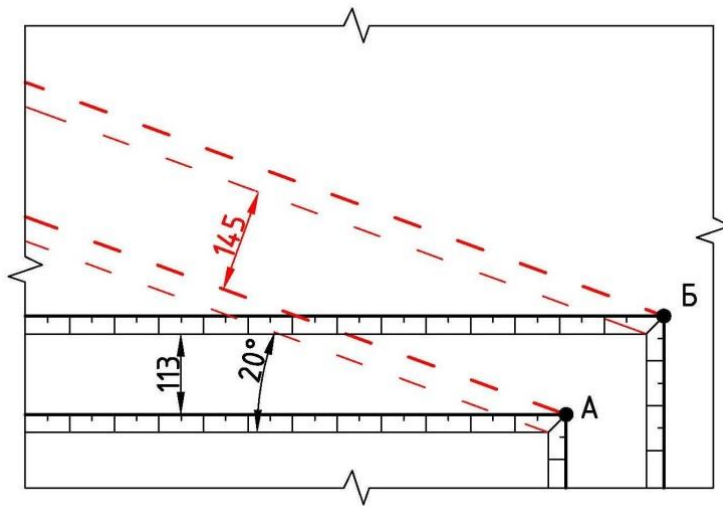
Изменение ширины условной рабочей площадки при повороте фронта работ на 20°
